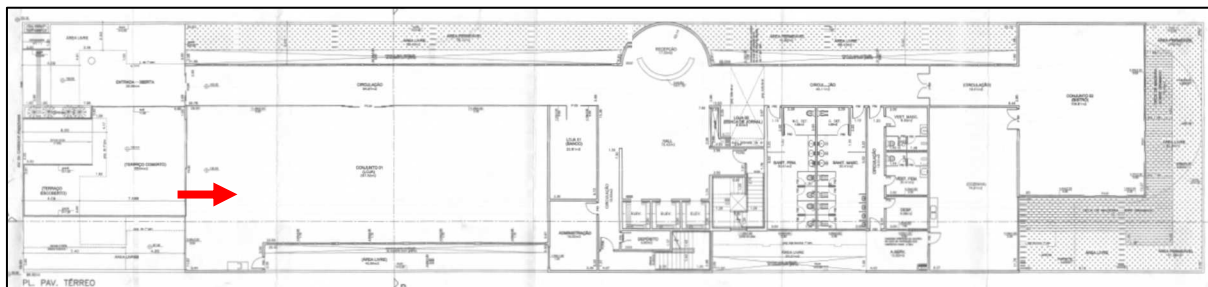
Sala 1 do pavimento térreo.
